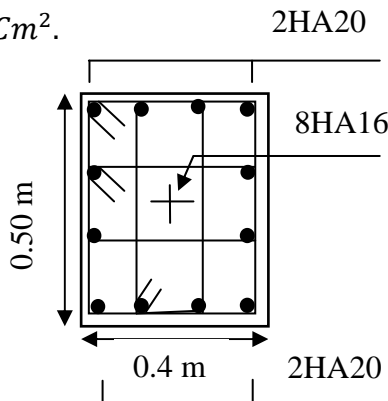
Schéma de ferraillage des poteaux rectangulaires de section (40 X 50) Cm².
